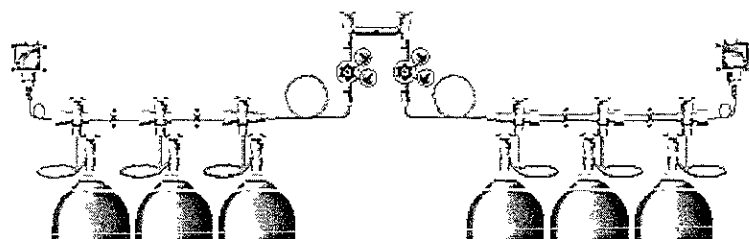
manifold doble que cuenta con tres cilindros de cada lado
